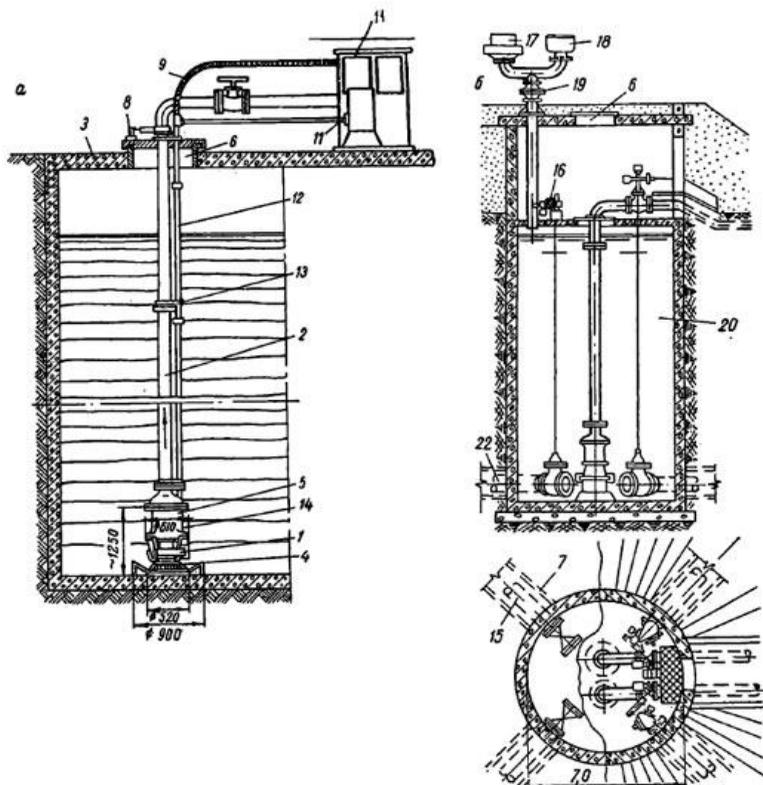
Способы установки погружных насосов: а - на покрытии резервуара; б - в колодце, для обслуживания четырех резервуаров (разрез и план). 1 - насосная часть; 2 - напорная колонка; 3 - резервуар; 4 - опора с фильтром; 5 - электродвигатель; 6 - люк; 7 - канал к резервуару; 8 - опора трубопровода; 9 - кабель; 10 - cabina электрического управления; 11 - маслопровод; 12 - токопроводящий кабель в масляной трубке; 13 - хомут; 14 - протектор с устройством для гидрозащиты; 15 - подводящий трубопровод; 16 - электродвигатель для привода задвижки; 17 - дыхательный клапан; 18 - предохранительный клапан; 19 - огневой предохранитель; 20 - колодец.
